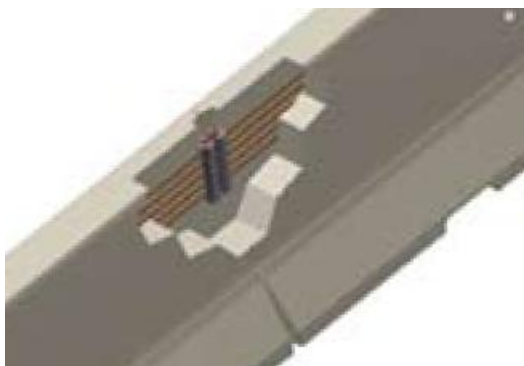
Barreiras de betão híbridas, betão e aço (9).
